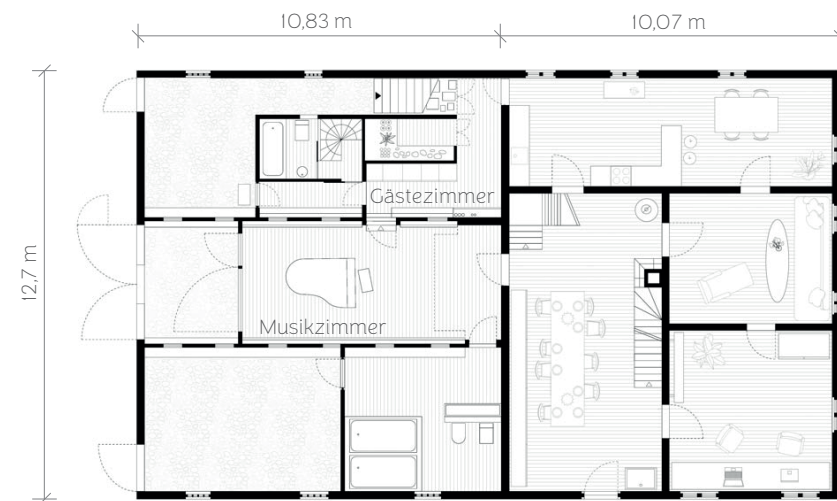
Grundriss Erdgeschoss, Zeichnung: Sigurd Larsen Architekten
